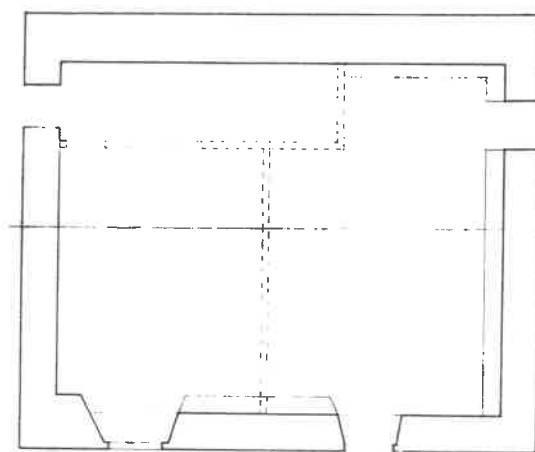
SARSINA - « Casa di Plauto »: sezione dell'ultimo piano.
